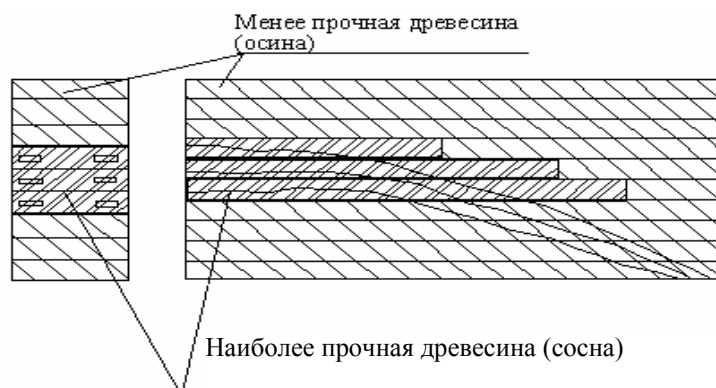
Схема комплектования клееной конструкции и способ ее усиления армированием
